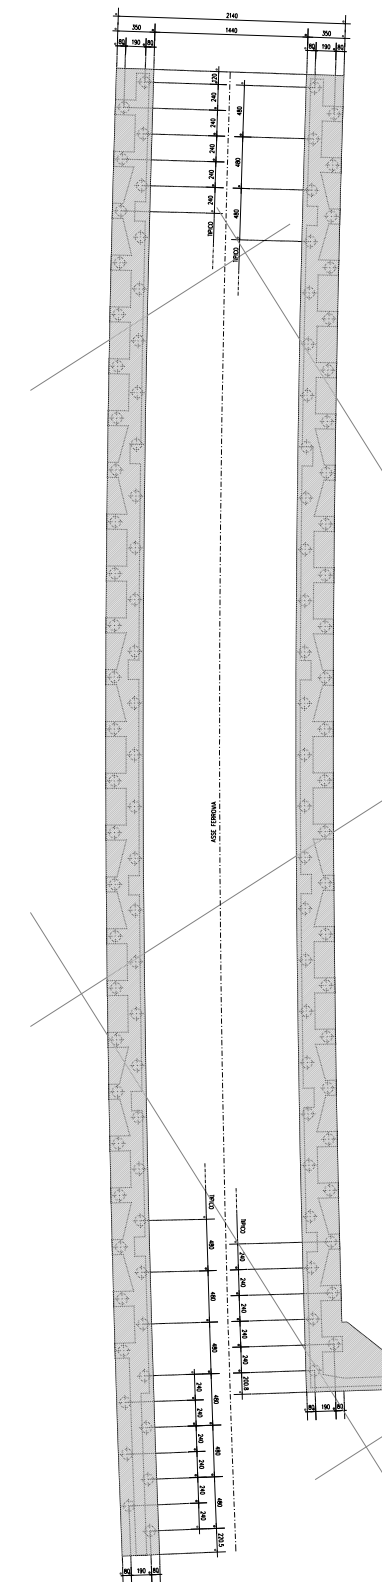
Pianta delle fondazioni della galleria ferroviaria
